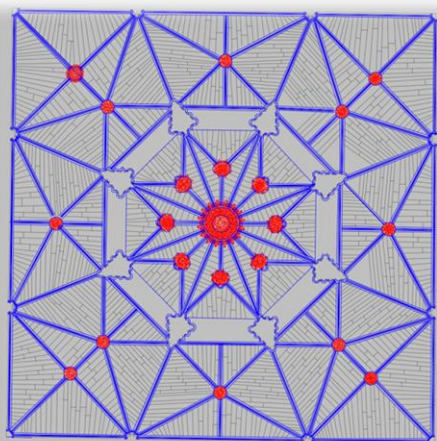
Planta de Tetos (Fonte: Direção do Mosteiro da Batalha)
